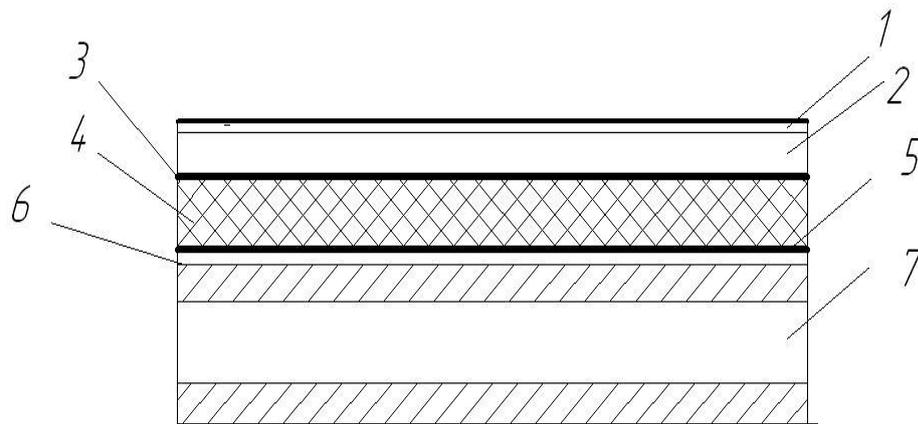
Схема для розрахунку коефіцієнта теплопередачі горішнього перекриття: 1 – ізопласт; 2 –стяжка; 3 – гідроізоляція; 4 – утеплювач; 5 – пароізоляція; 6 – вирівнююча стяжка; 7 – плита покриття
